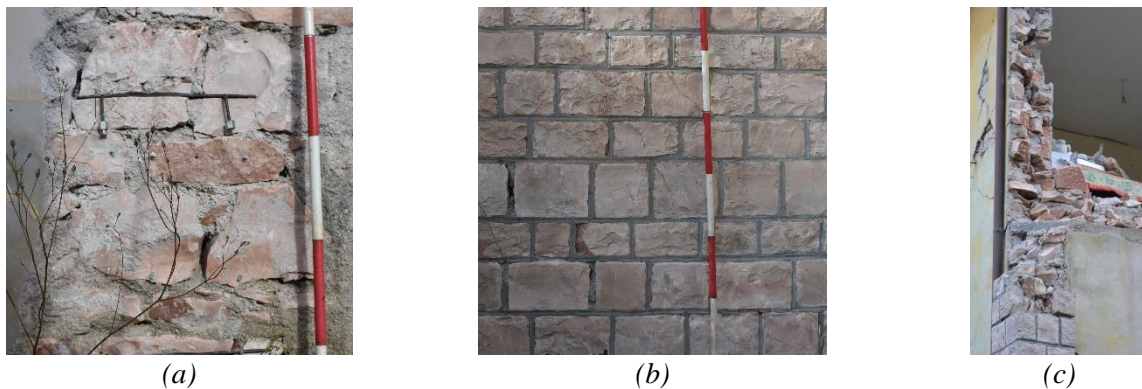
Tipi murari nell'edificio caso studio: (a) M1, prospetto; (b) M2, prospetto; (c) M1 e M2, sezione comune ad entrambi i tipi murari.
